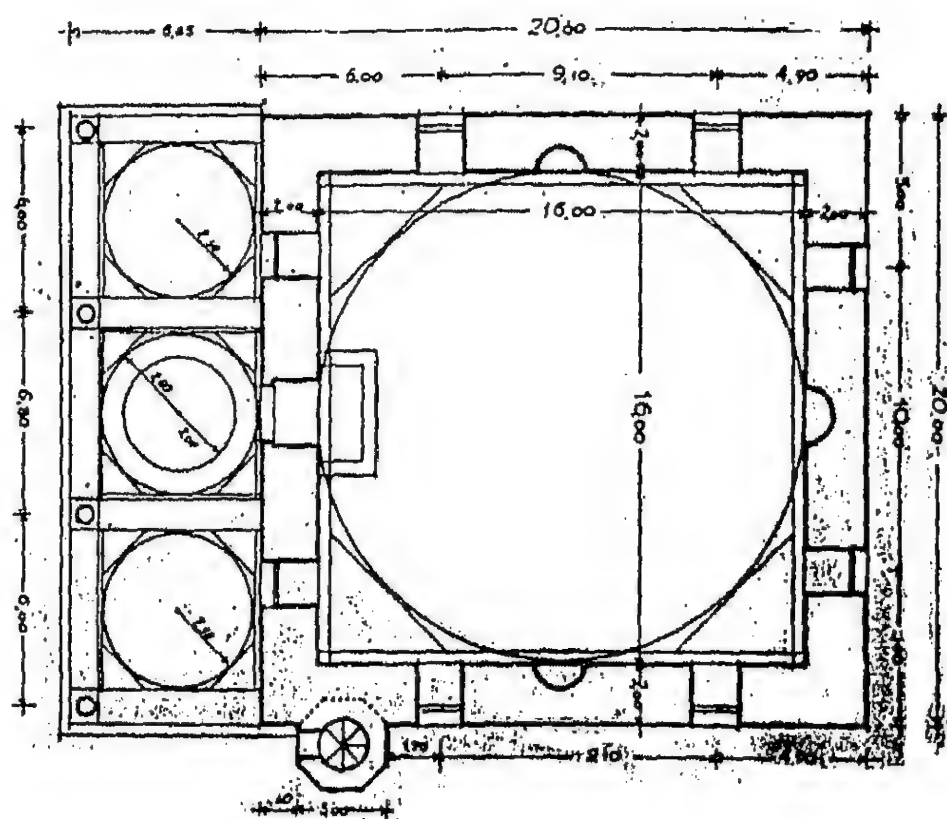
مسقط أفقي لمسجد محمد بك في سيريز (عن : كيل) .
